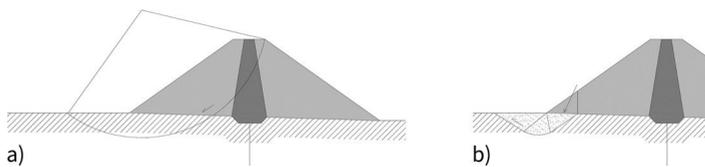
Beispiele für das Versagen durch mechanischen Grundbruch (nach [29]);
